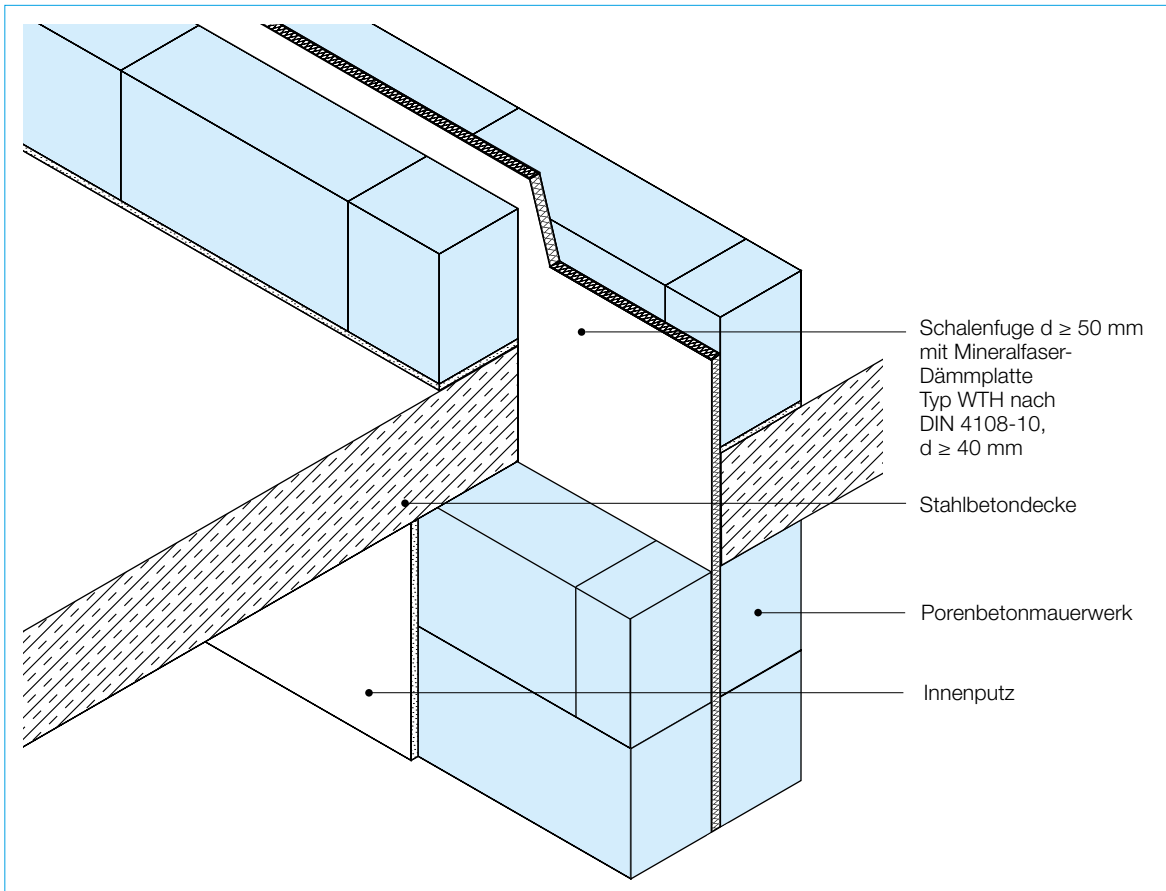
Zweischalige Haustrennwand aus Porenbetonmauerwerk – Anschluss an Stahlbetondecke
